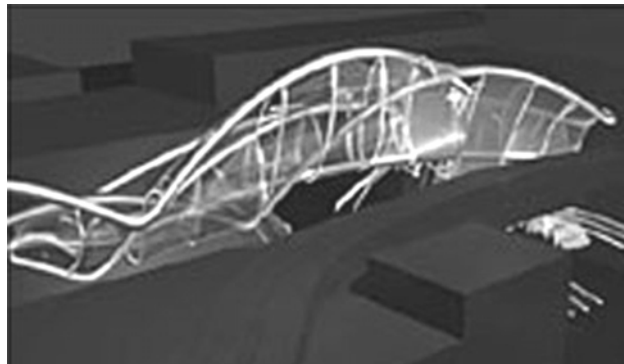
TRIPLE BRIDGE GATEWAY TO 9TH AVENUE
